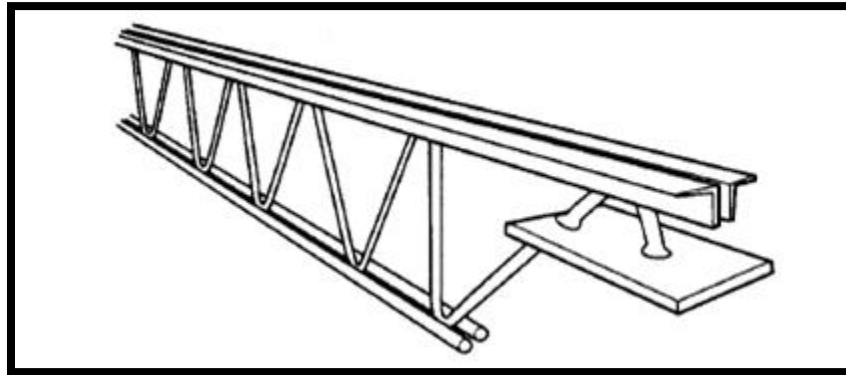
(c) (): Ejemplos de obstáculos constructivos-construcción con viguetas de celosía con alma abierta.
